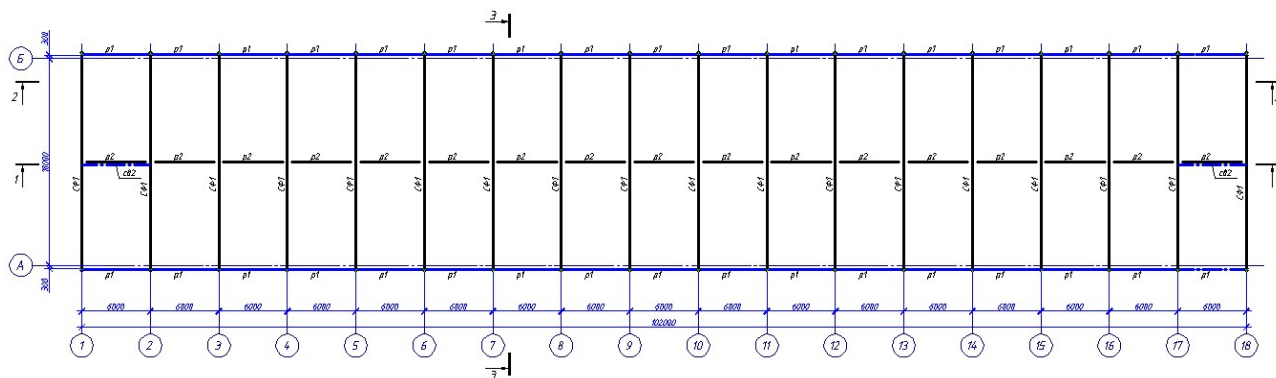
Схема расположения стропильных ферм и связей в уровне нижнего пояса ферм
